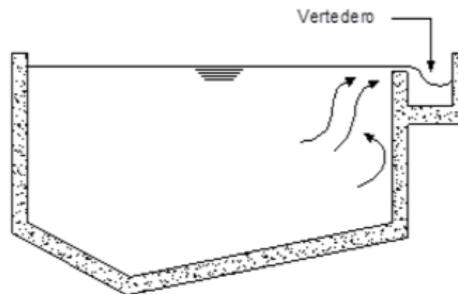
Esquema de la tolva de arenas – planta
